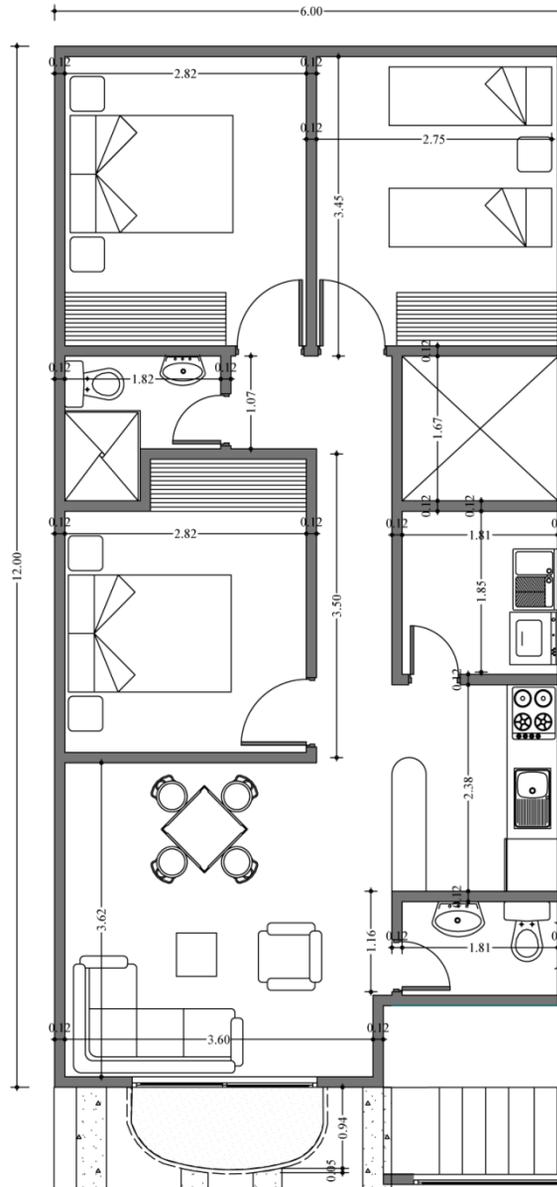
Planta arquitectónica segundo piso vivienda trifamiliar
